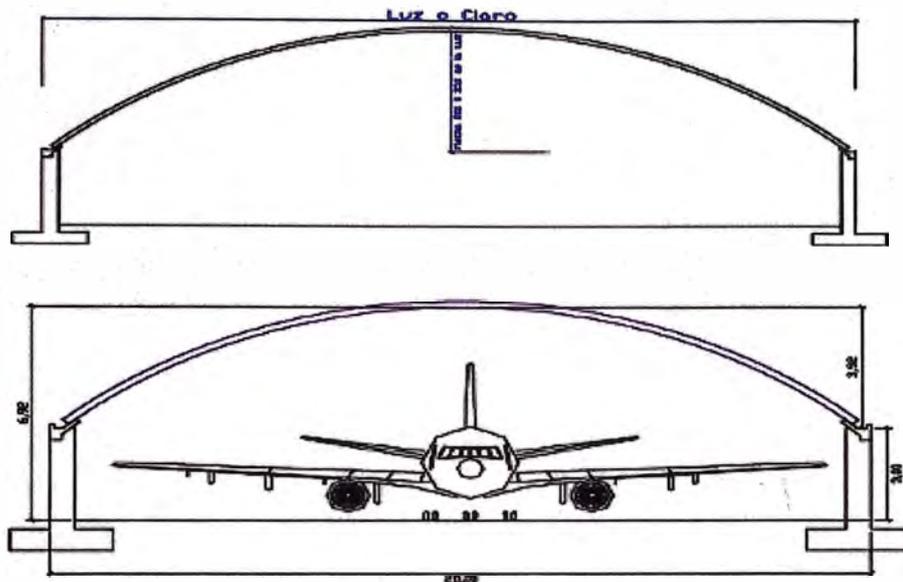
Sección típica de un techo Auto soportado tipo membrana.
